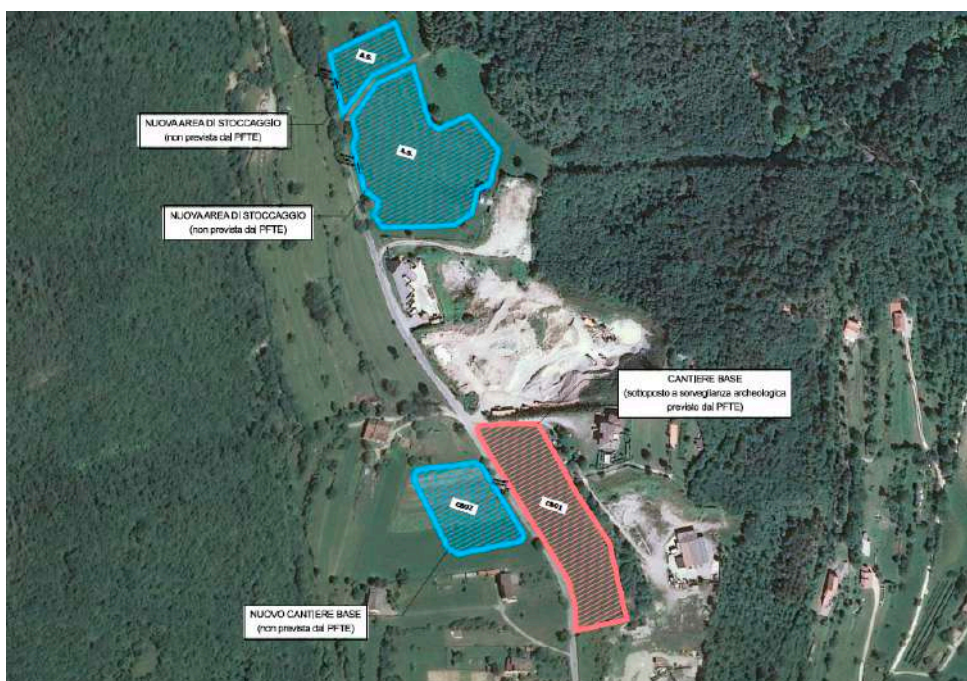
Planimetria di confronto aree di cantiere già previste dal PFTE (rosa) ed introdotto nel PD (azzurro)
